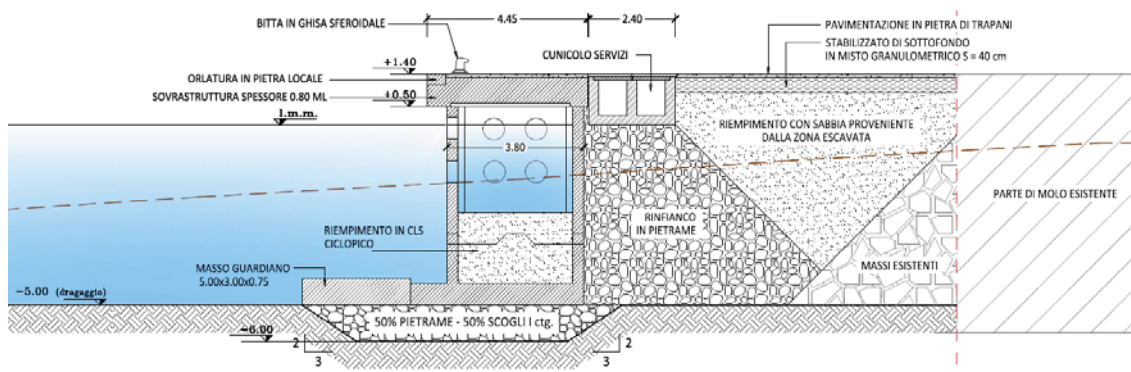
Sezione prolungamento molo di Levante – Tratto di raccordo
